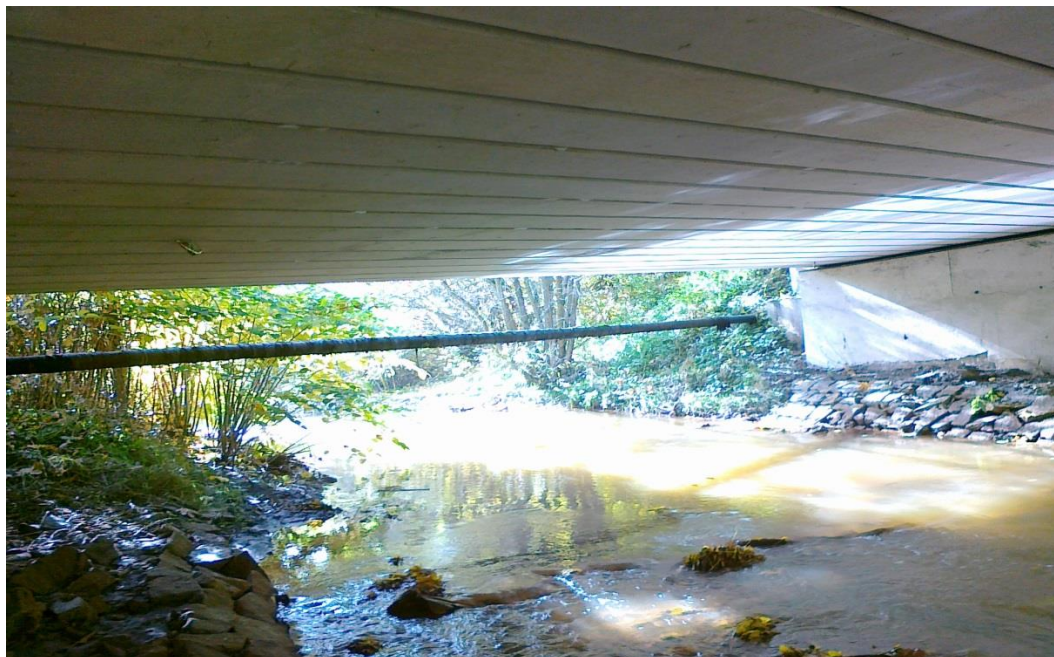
J/w widok spodniej powierzchni dźwigarów belkowych - stan powierzchni żelbetowej płyty pomostowej dostateczny, widoczne drobne wykruszenia betonu i miejscową lekkoporowatą strukturę przypowierzchniową betonu.
